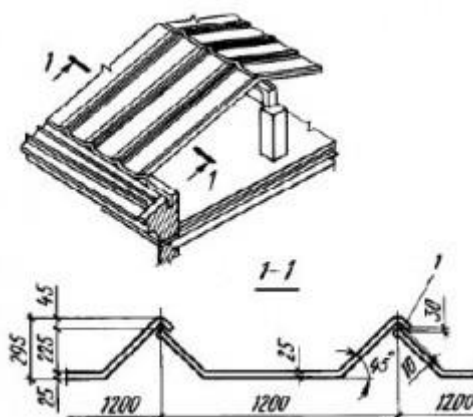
Сборная железобетонная скатная крыша из складчатых панелей трапецидального профиля: 1 — цементный раствор
